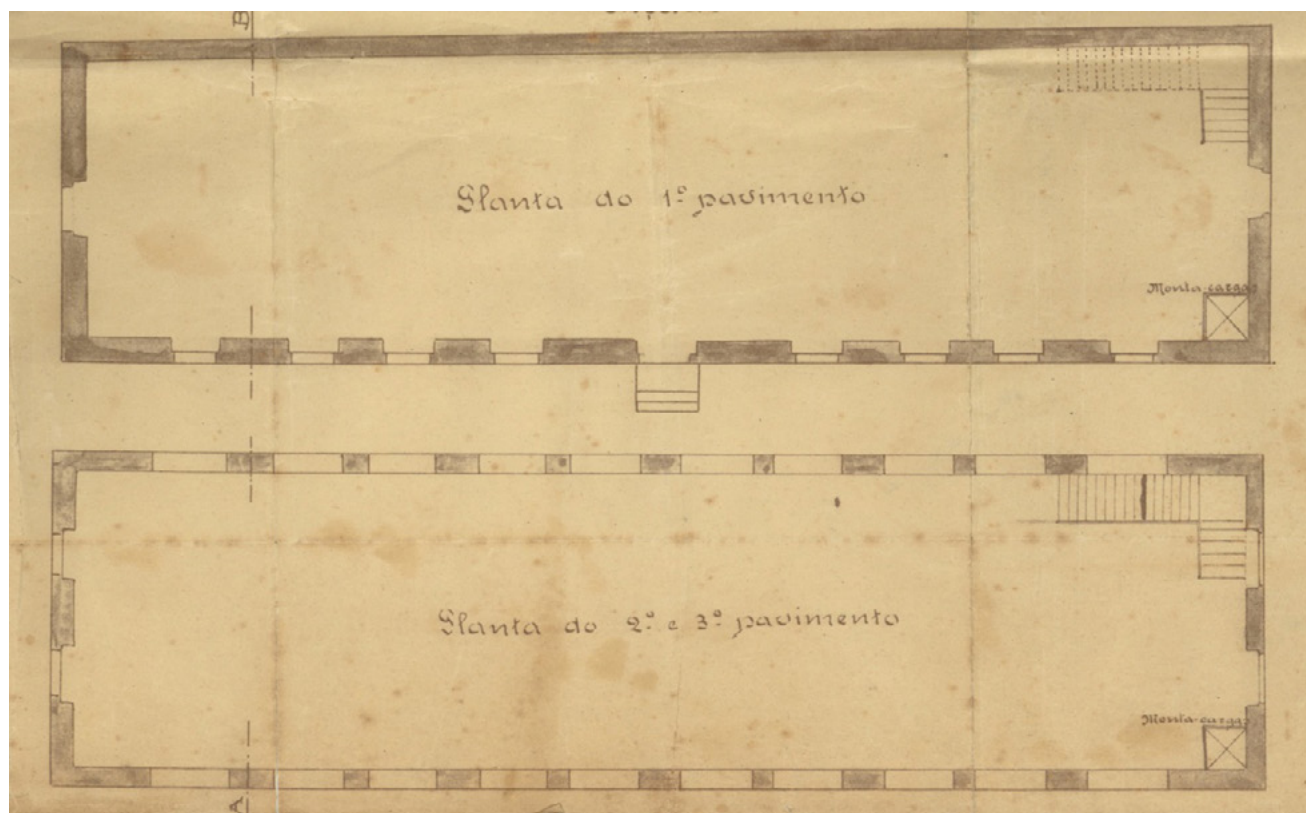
Plantas dos 1.º, 2.º e 3.º pavimento. Fonte: Arquivo APA.
